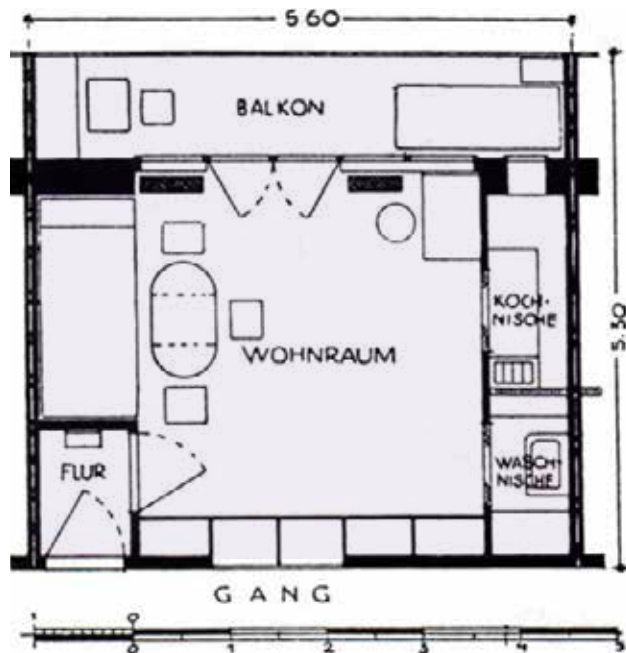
Wohnung der berufstätigen Frau, Elementgrundriss TYP III, 1927
